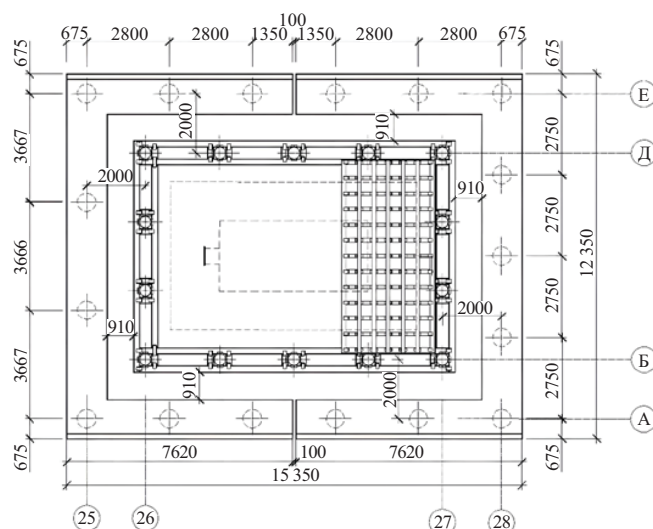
План водоприемного оголовка с защитными железобетонными конструкциями [9]
